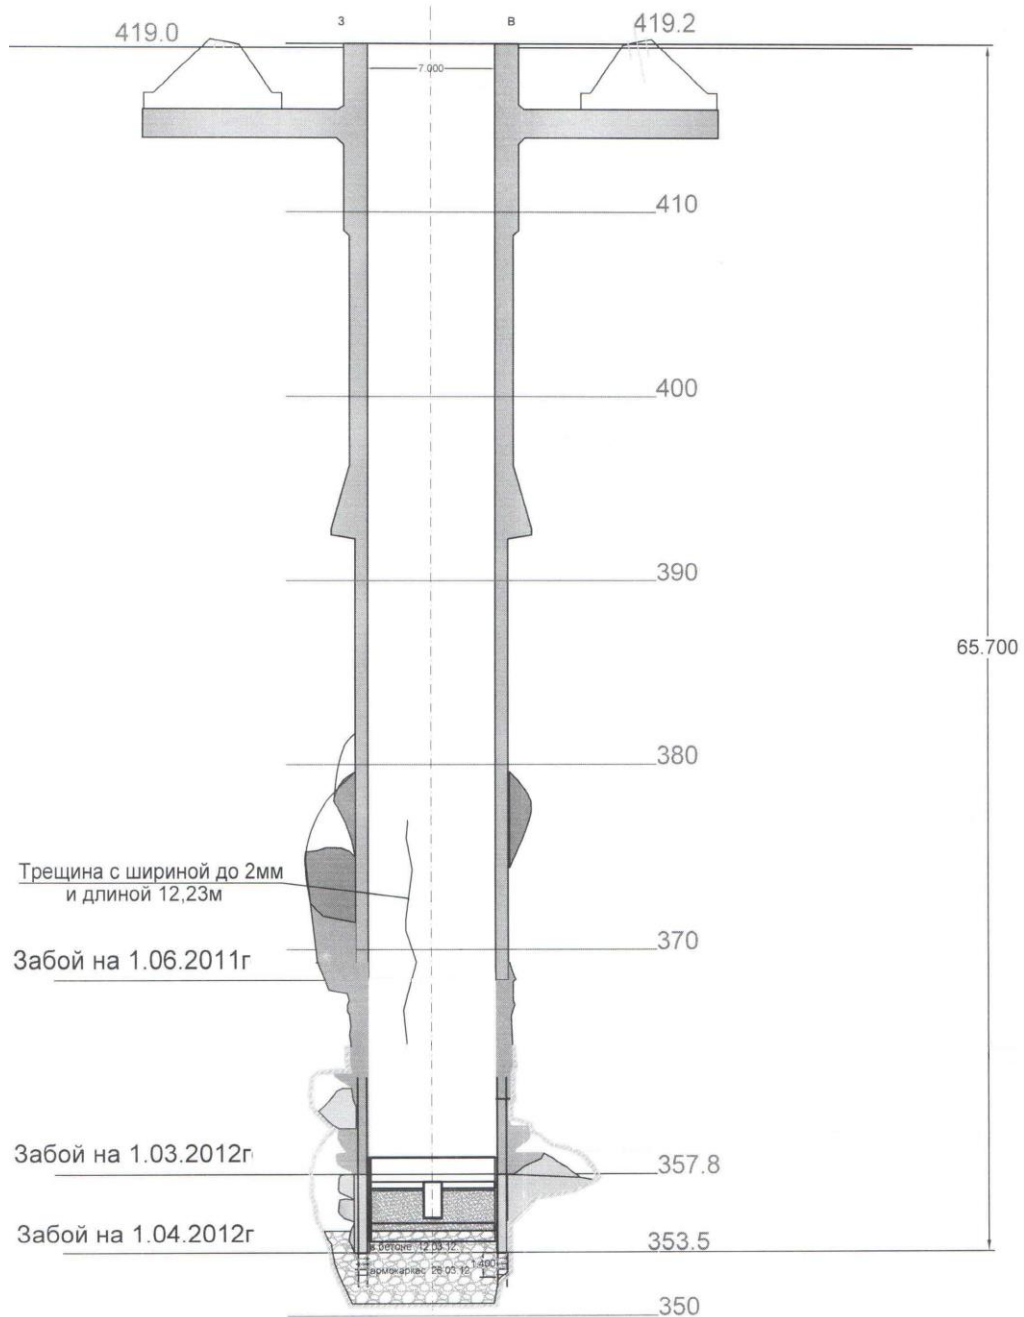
Вертикальное сечение ствола «Южный Вентиляционный» с местами произошедших вывалов закрепного пространства и трещинообразований в железобетонной крепи
